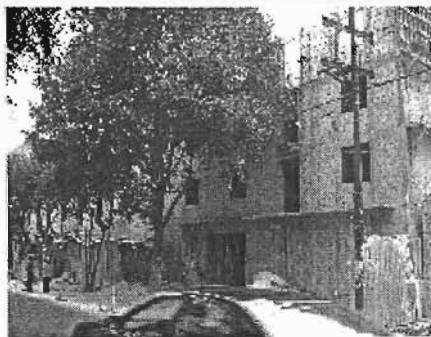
Mampostería con refuerzo y ladrillo hueco
